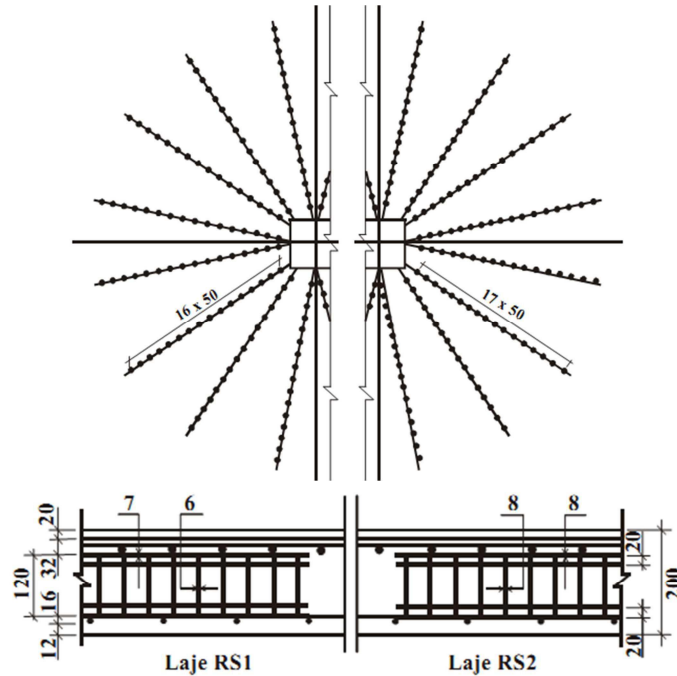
Detalhe da armadura de cisalhamento utilizada nas lajes RS1 e RS2 (Regan e Samadian, 2001)
